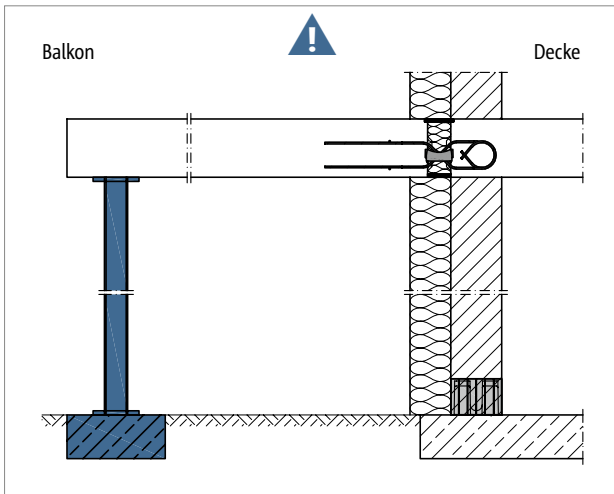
Schöck Isokorb® T Typ QL-VV: Stützung durchgängig erforderlich
